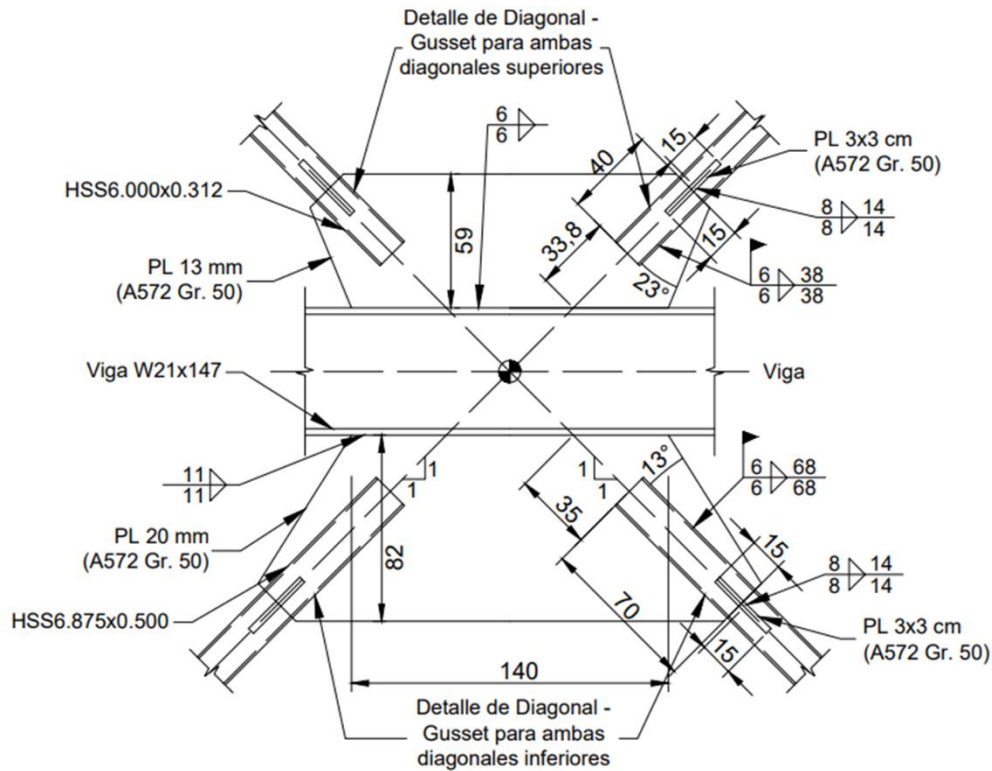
Detalle de conexión soldada al gusset. Medidas en cm y espesor de soldaduras en mm.
